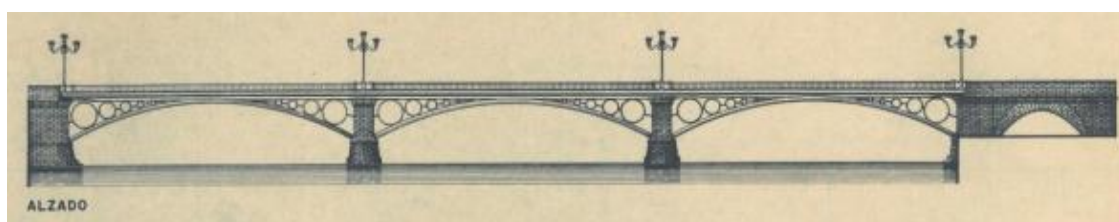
Alzado del puente. Fuente: (Ríos Pérez, 2017)
